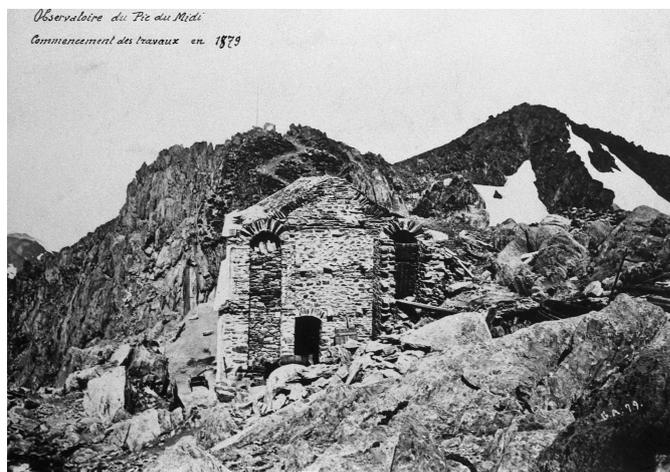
Les travaux de construction du bâtiment Nansouty en 1879 |
